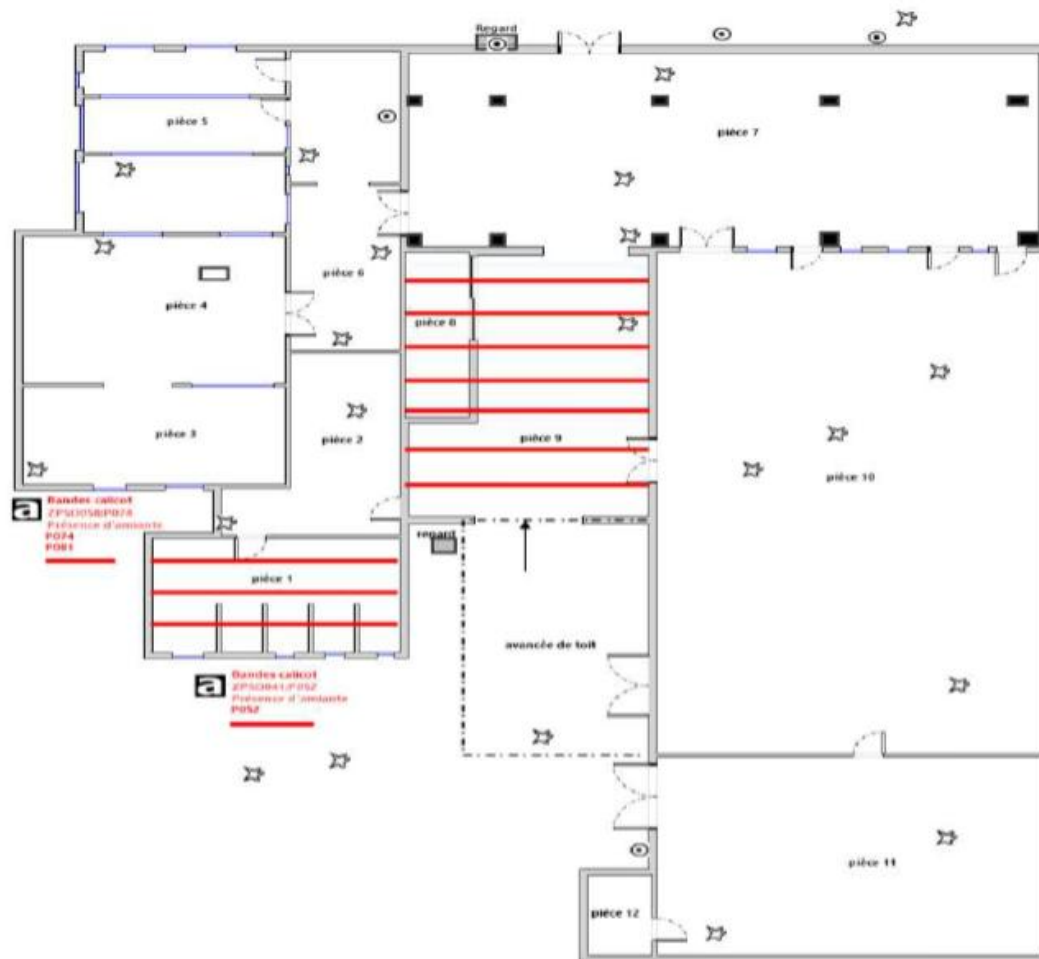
Plan des prélèvements au niveau des plafonds enduit plâtreux contenant de l'amiante dans le bâtiment 3
